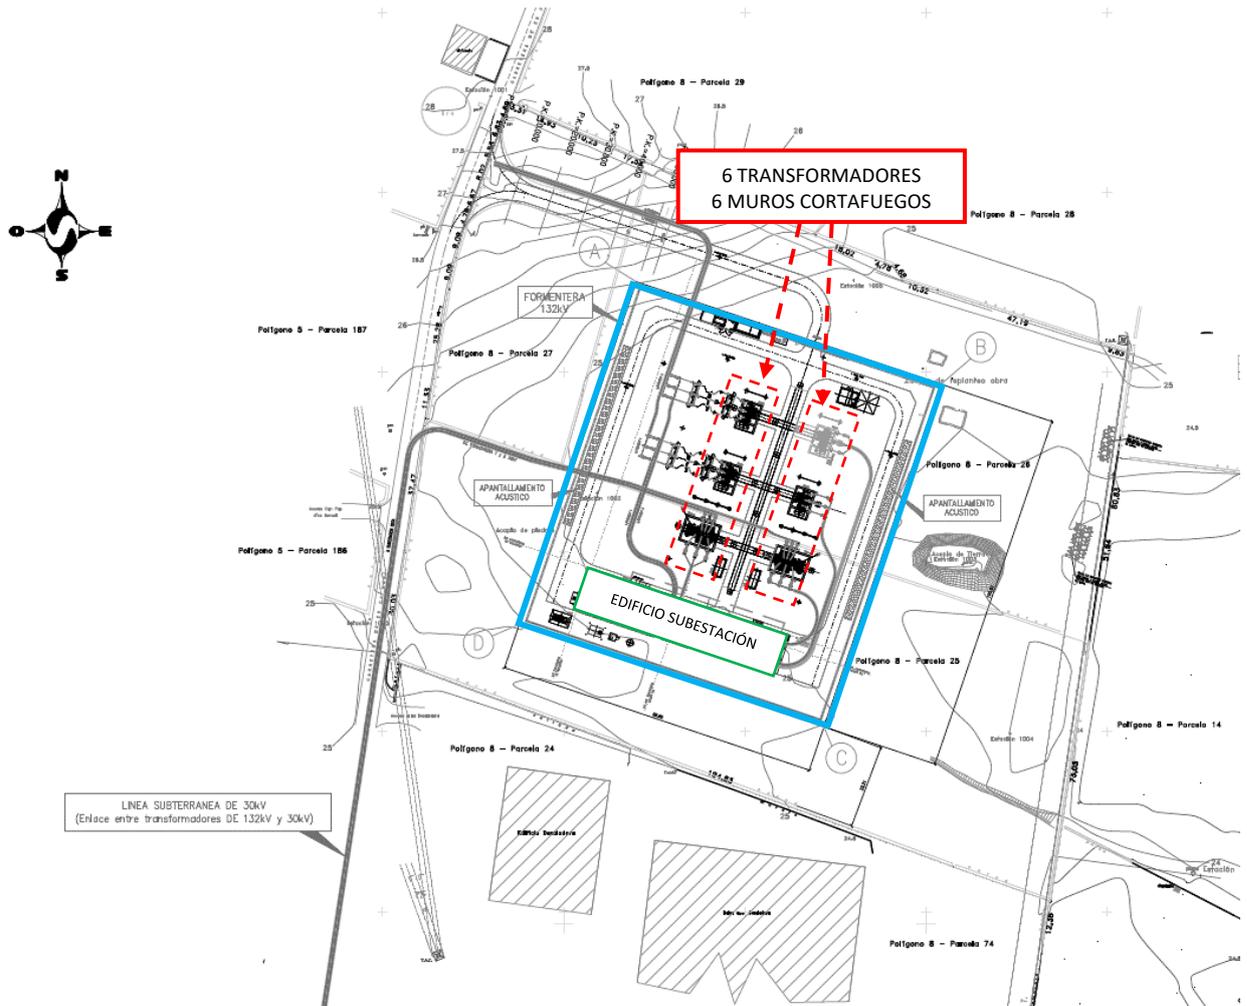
Vista en planta de la parcela y nueva subestación prevista
